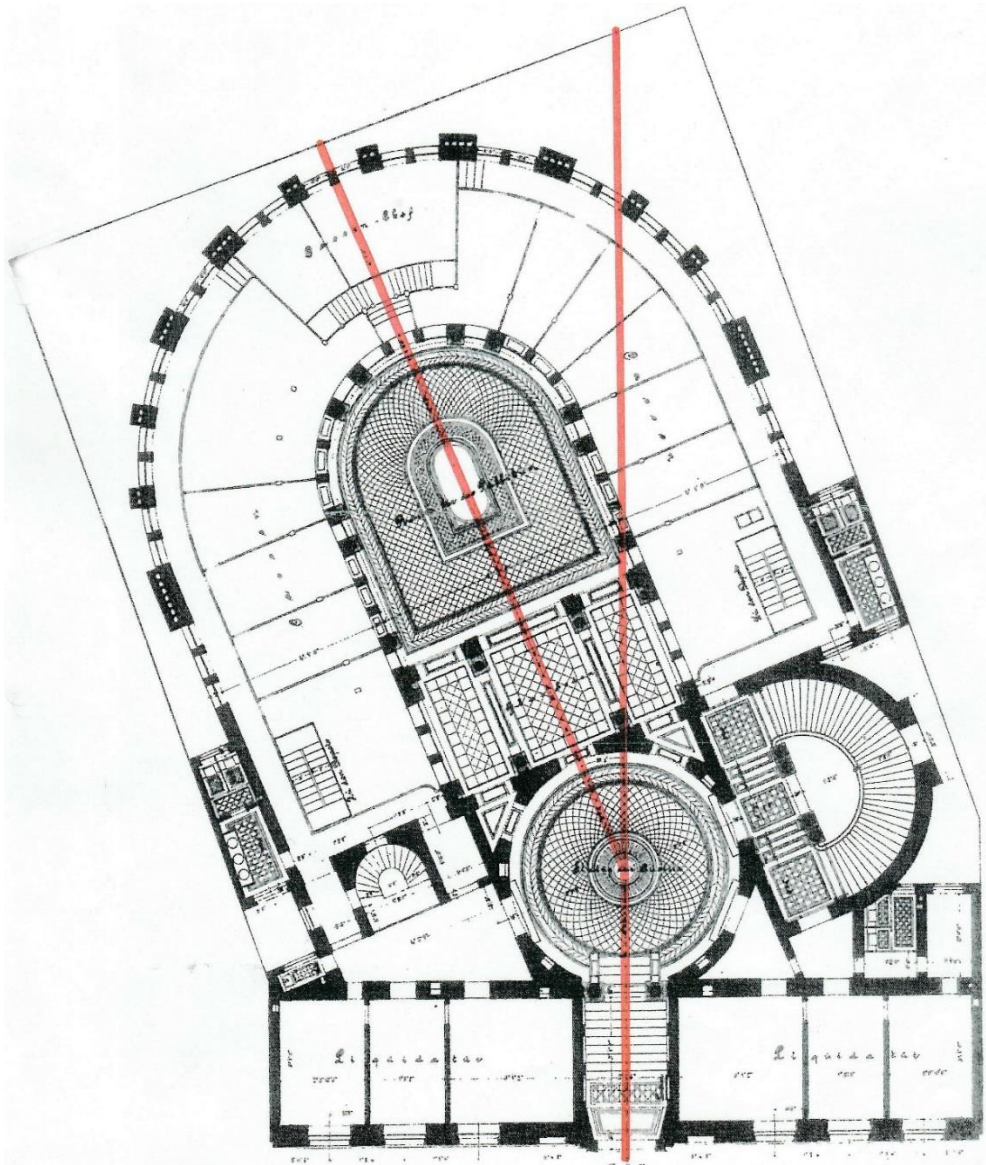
Grundriss, Erdgeschoß der Österreichischen Länderbank, Otto Wagner, 1882
